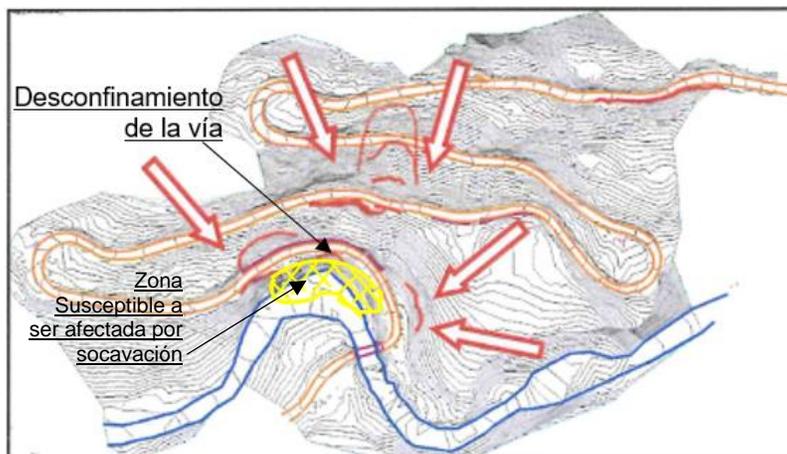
Vista en planta del sitio crítico 23,24 y 25.
